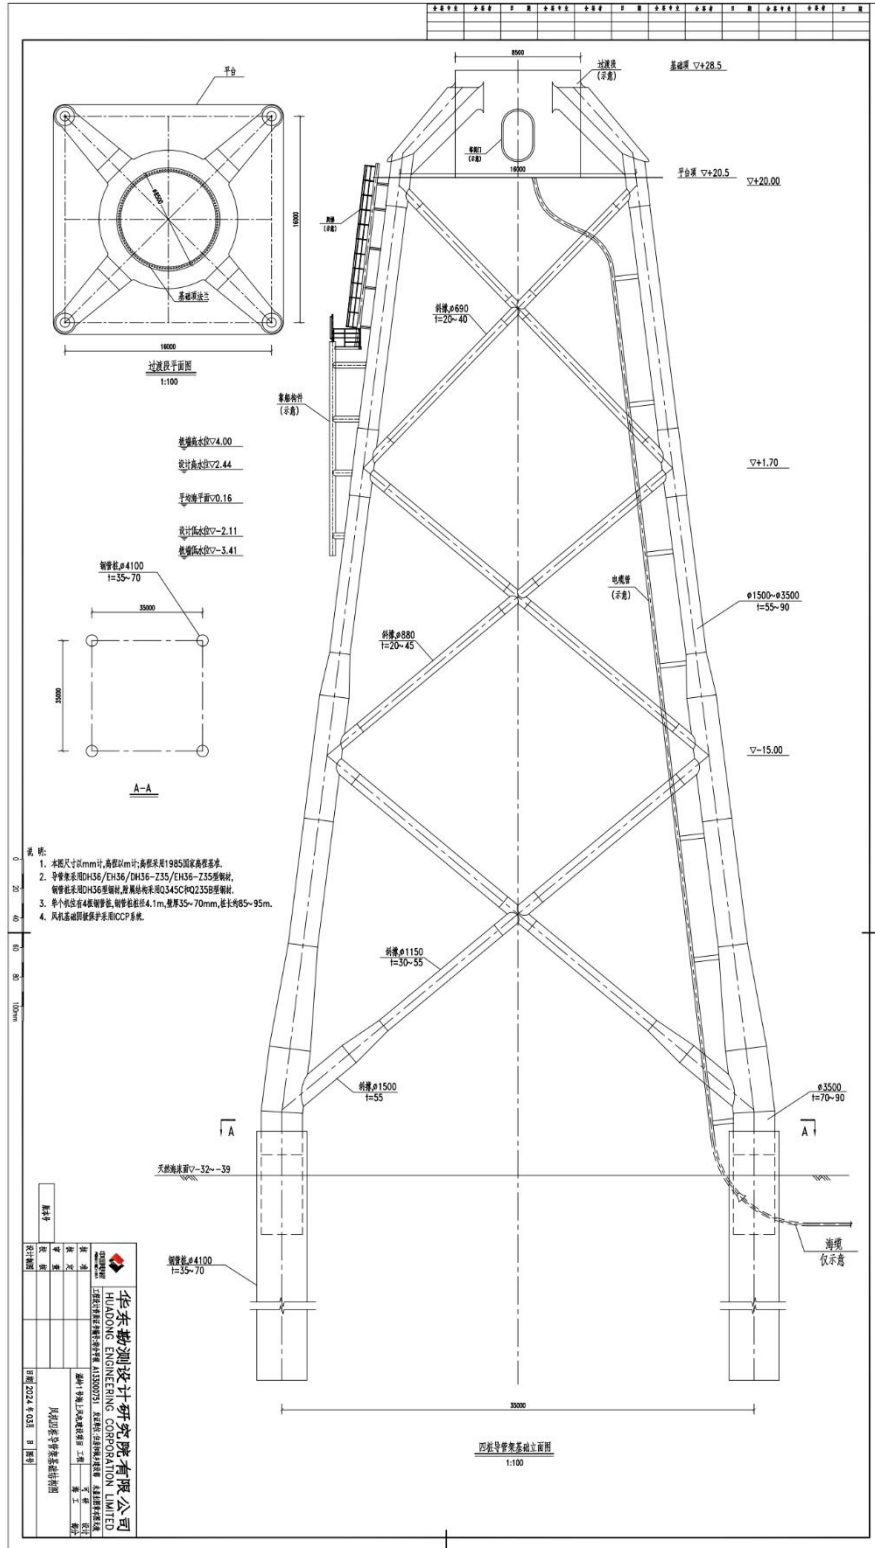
四桩桁架导管架风机基础结构布置图
